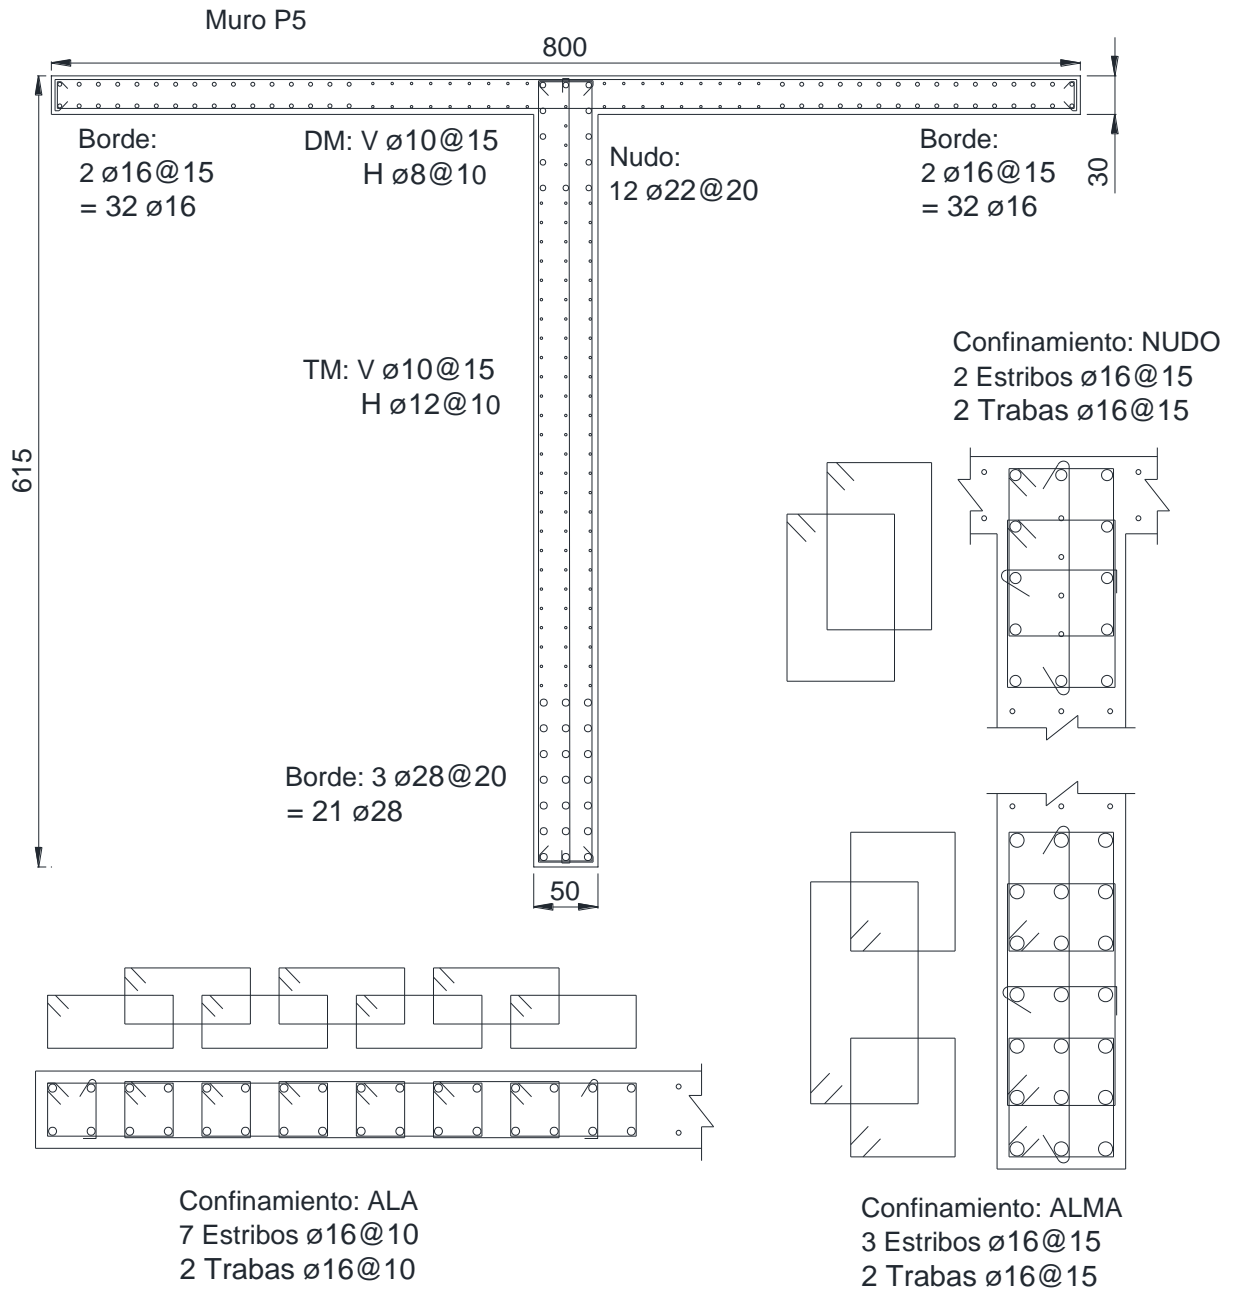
Armadura longitudinal, transversal y de confinamiento para el muro P5
